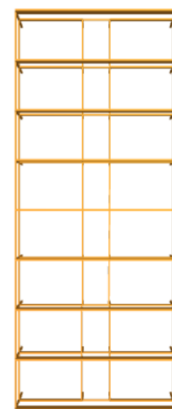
Betongkonstruksjon. Ovenfra. (Fokus konstruksjon)
